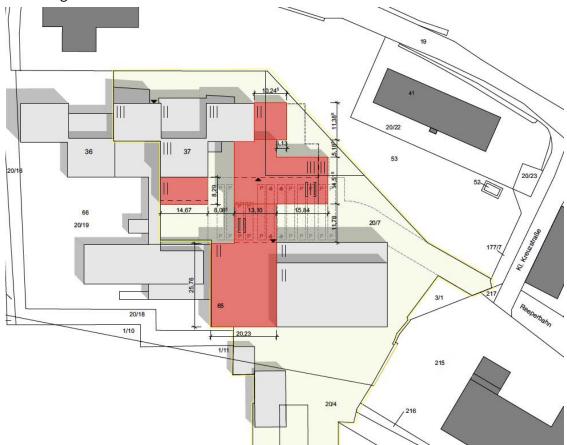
Lageplan des Bestands mit der in rot dargestellten Erweiterung (Streich Grage Architekten 06/20)
